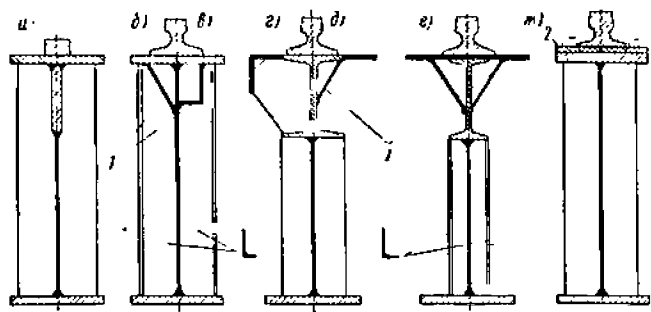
Схемы конструкций верхних поясов одностенчатых балок, уменьшающих местные напряжения от давления ходовых колес на кромке вертикальной стенки: 1 — листовые или уголковые элементы, образующие коробчатое сечение пояса; 2 — упругая прокладка
